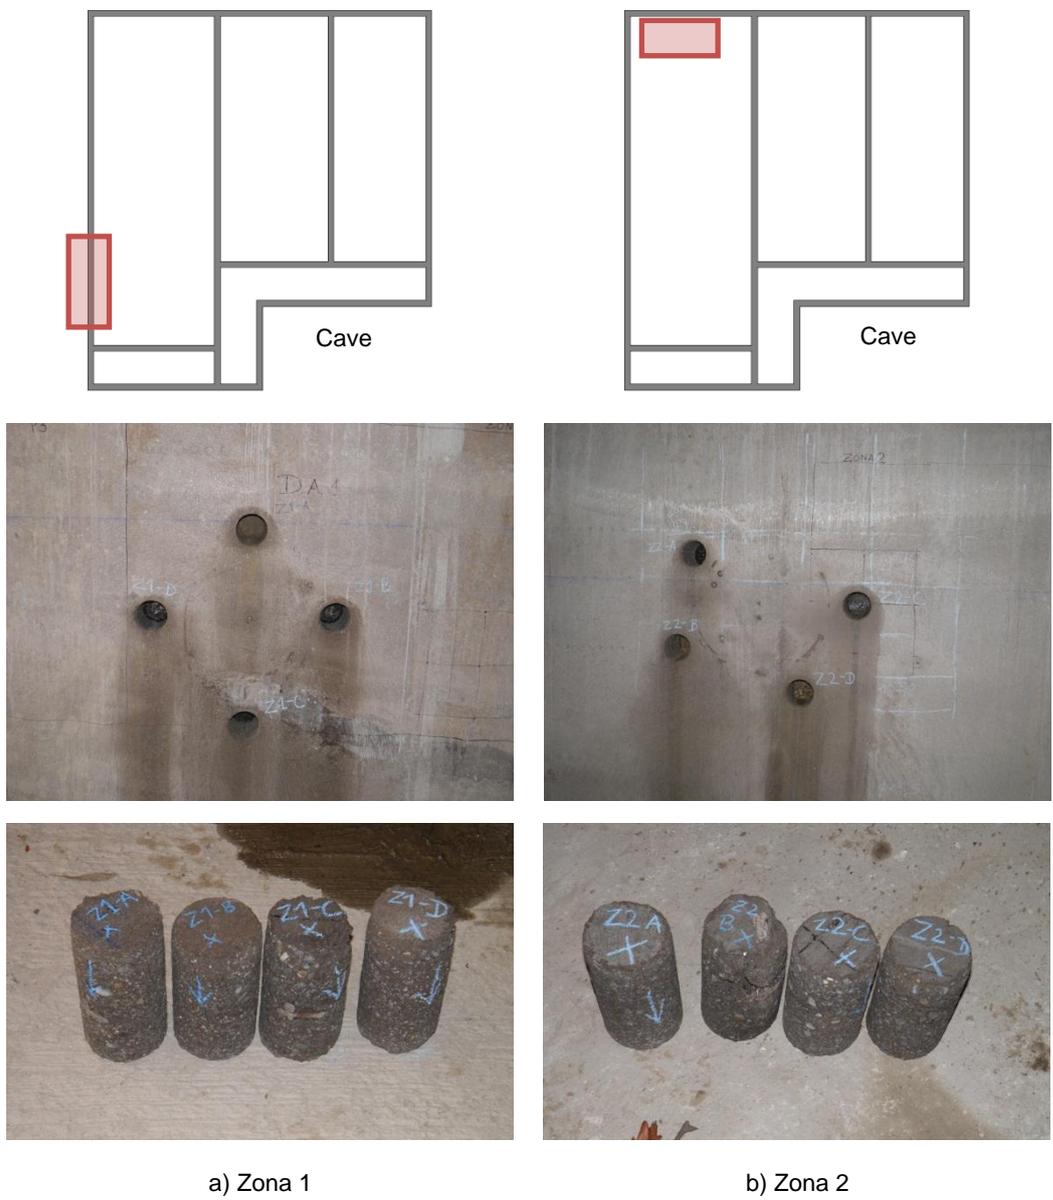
Zonas de carotagem e provetes extraídos
